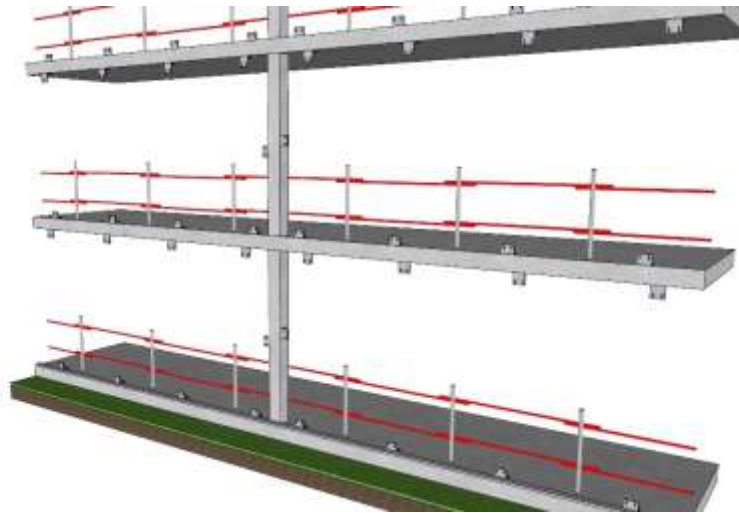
Pose des équerres d'ancrage sur et sous les planchers béton et sur les poteaux (FP2)
